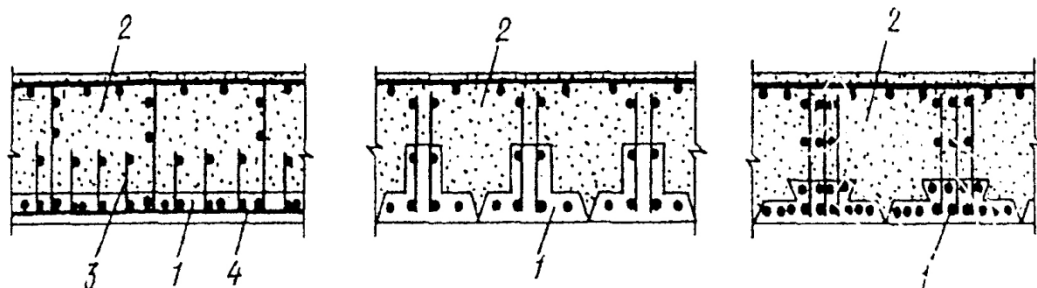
Сборно-монолитные железобетонные панели под большие нагрузки (до 500 кН/м²):
